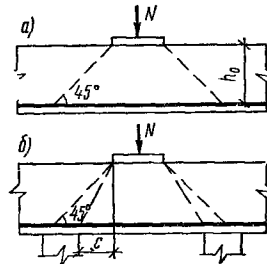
Схема пирамиды продавливания при угле наклона ее боковых граней к горизонтали
